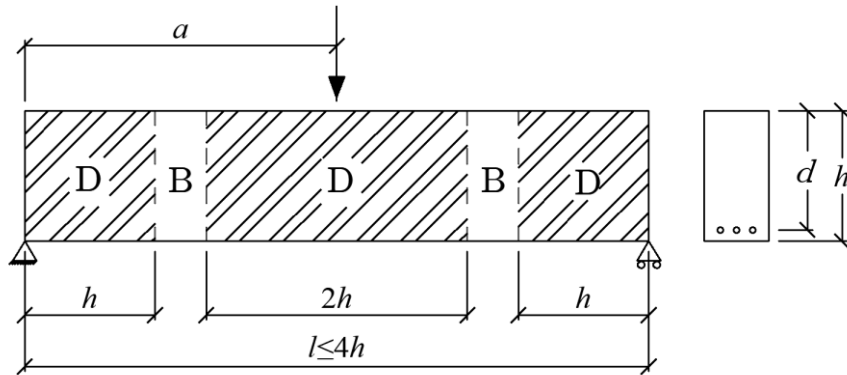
Définition d'une poutre profonde (adaptée de Schlaich et al. [13])
